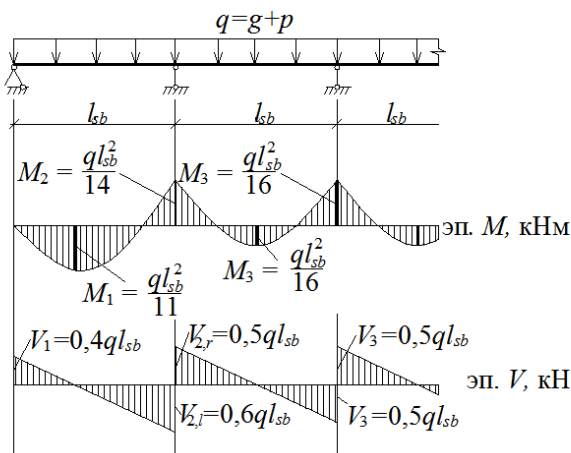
Расчетная схема и эпюры изгибающих моментов и поперечных сил второстепенной балки
